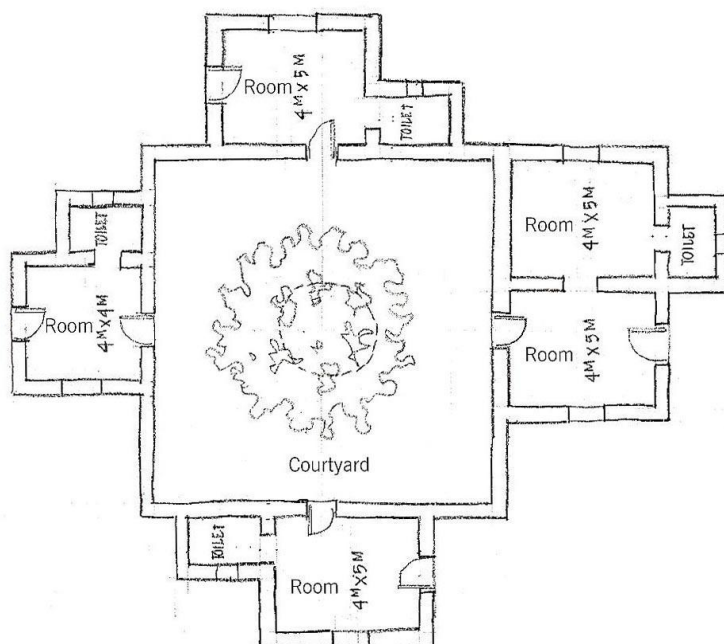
Plano de planta baja. Mehrauli Farm House
